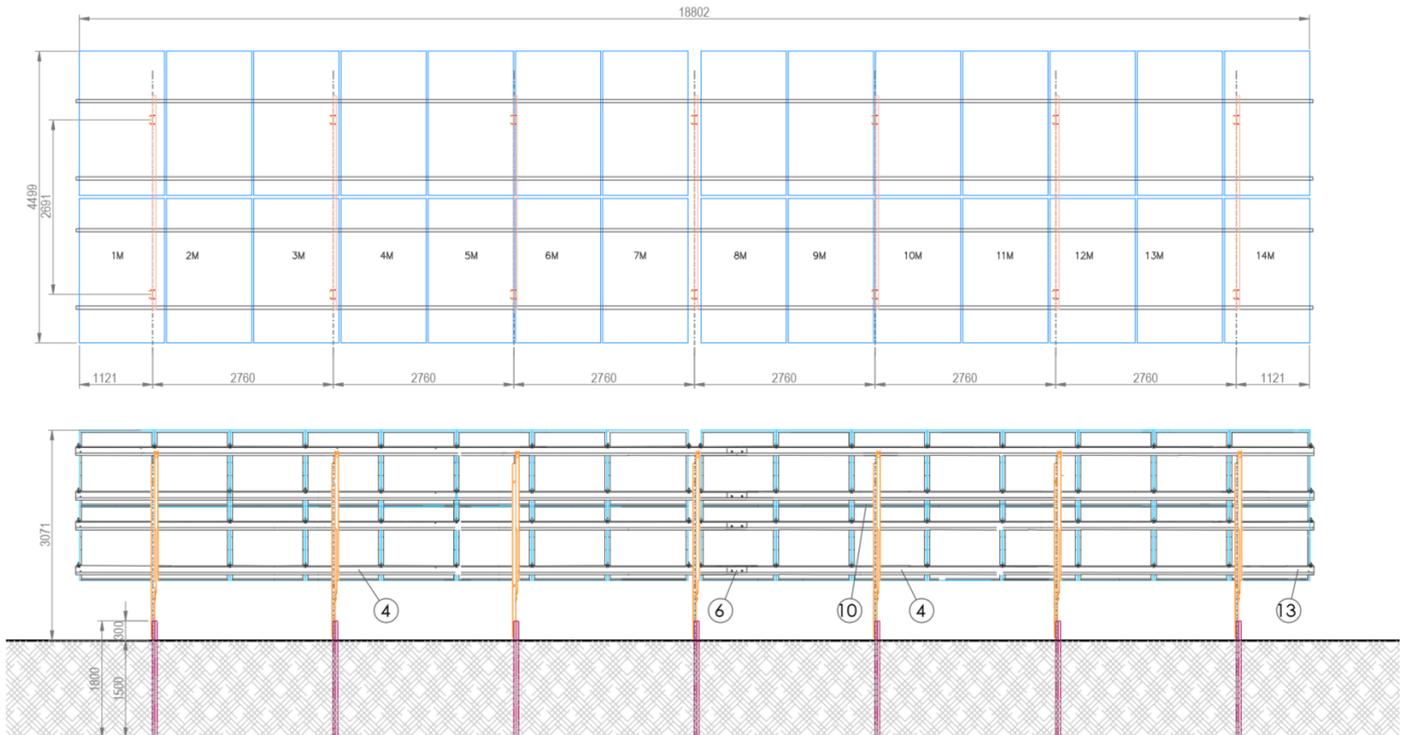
pianta e prospetto struttura di supporto 2x14 moduli
